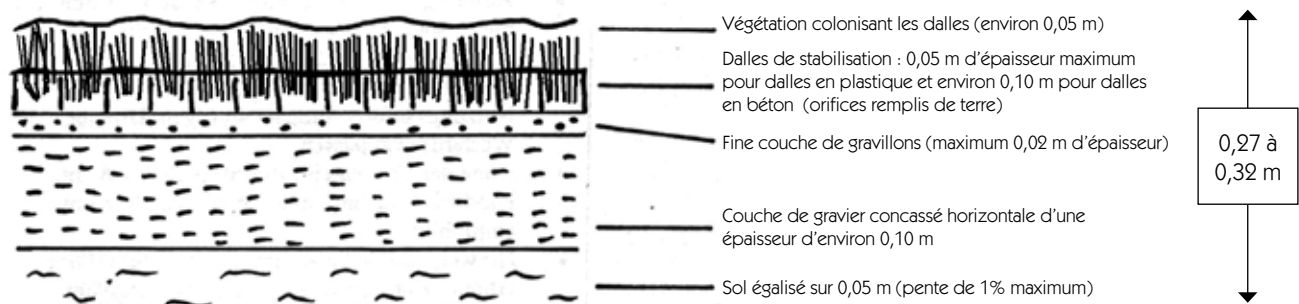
Dalles de stabilisation posées sur assise (vue en coupe)
